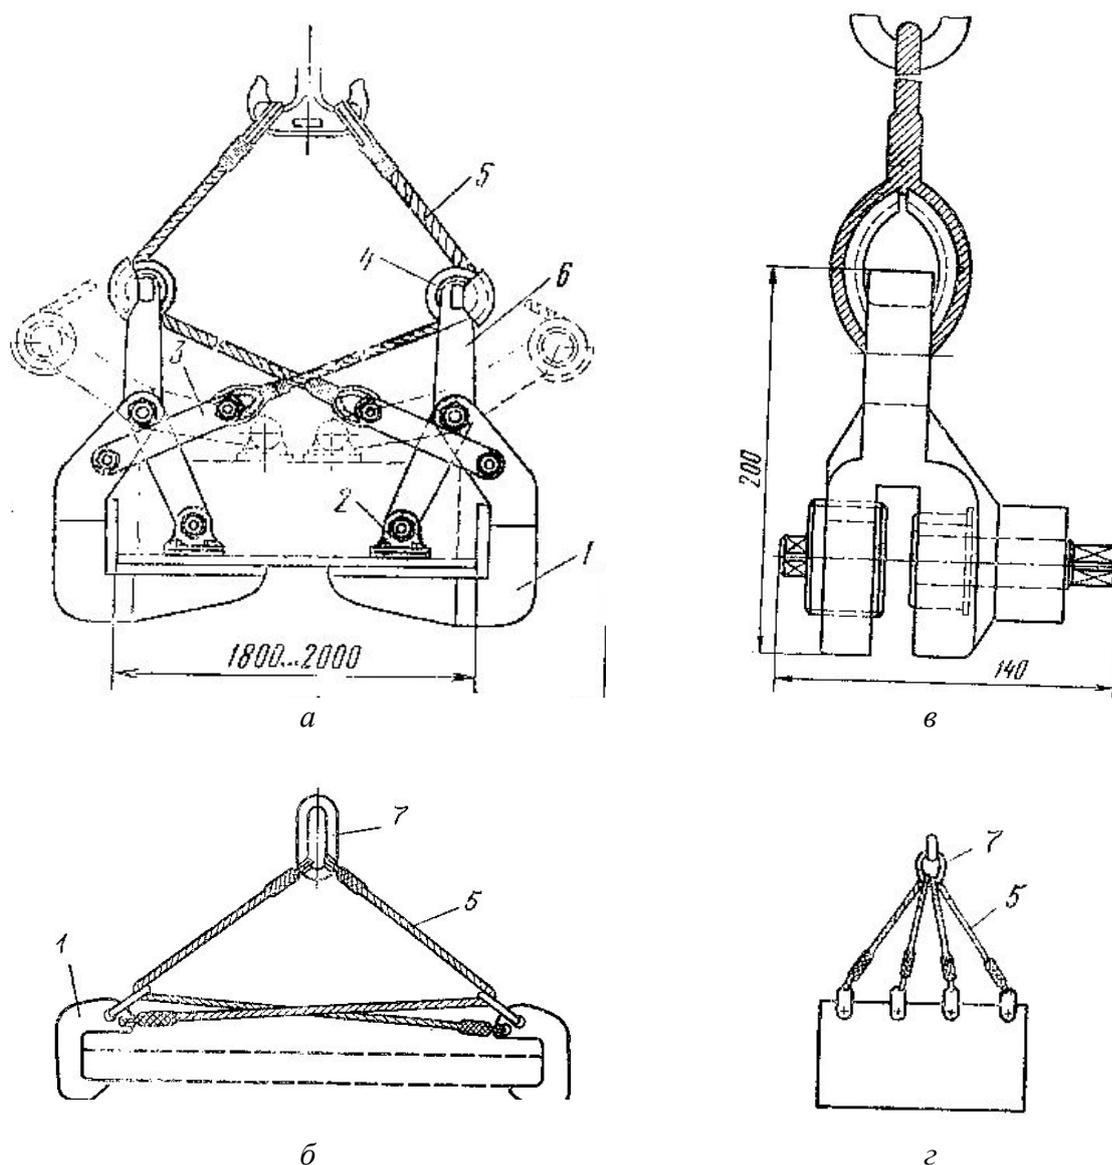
Стропы-захваты: а – захват для подъема плоских тел; б – строп-захват; в, г – захват-струбцина: 1 – скоба; 2 – прижимная губка; 3 – тяга; 4 – ролик; 5 – стальной канат; 7 – кольца
